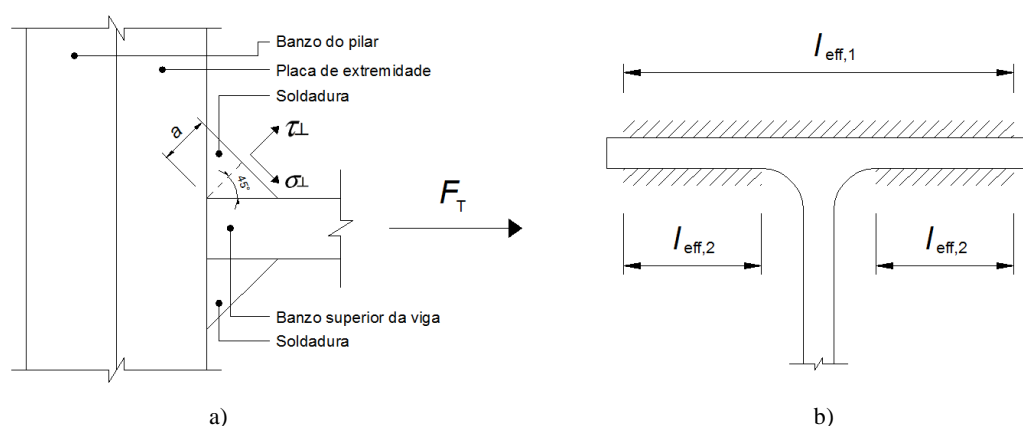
a) Corte longitudinal do banzo da viga. b) Corte transversal da viga (vista superior).
